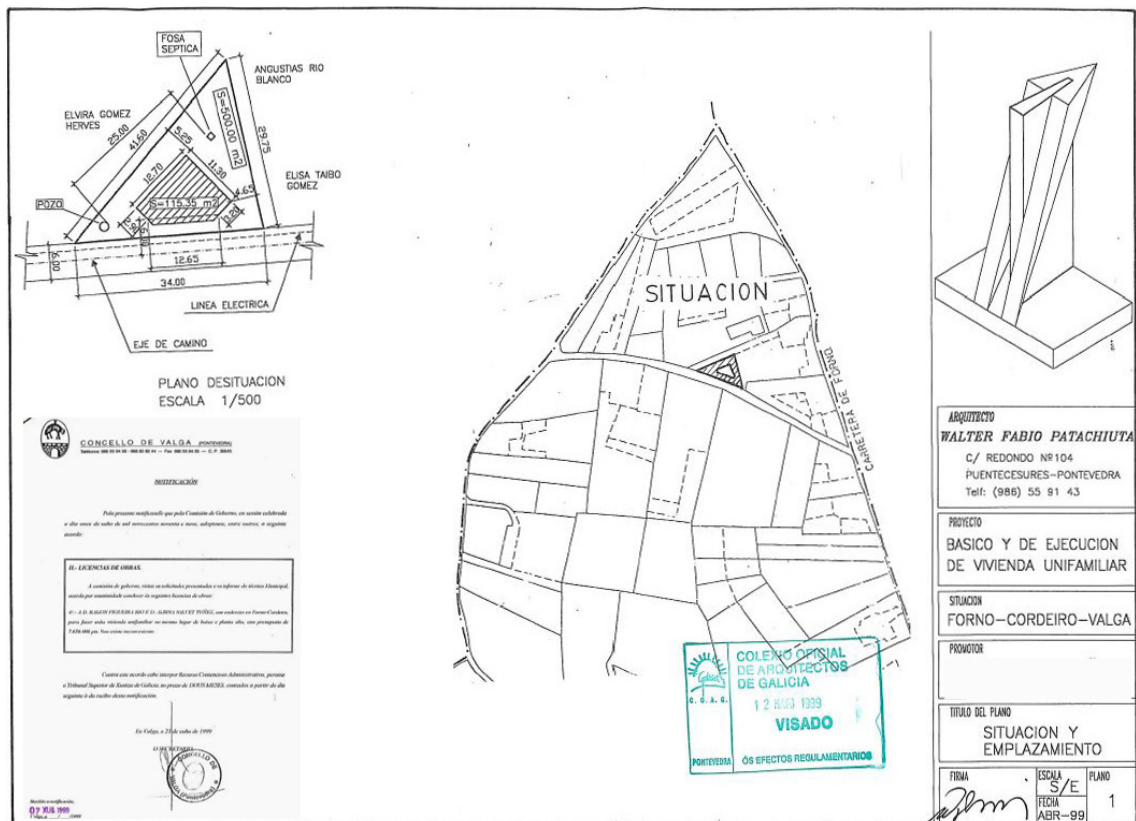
Plano de situación y concesión de licencia del plano anterior de 1999. Fuente archivo municipal.
